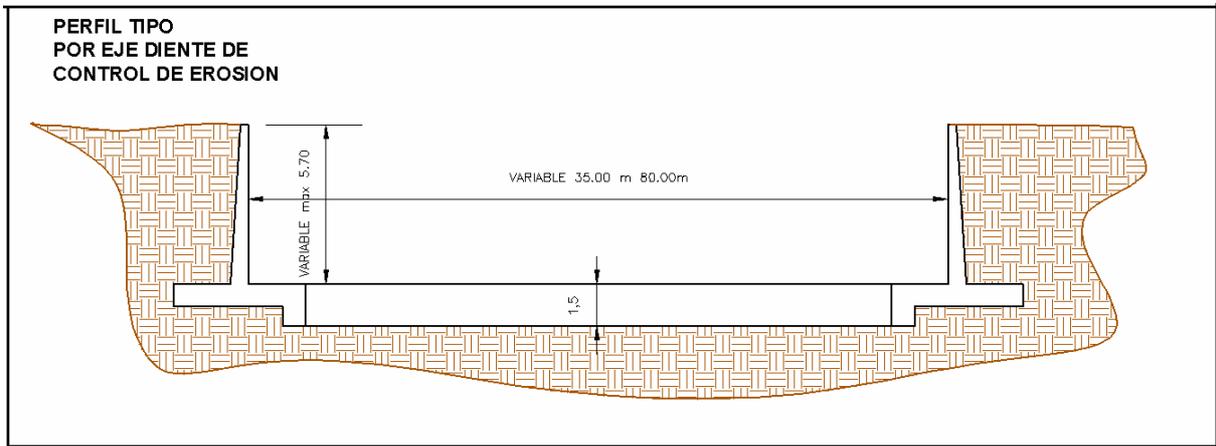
Perfil Transversal Tipo de la Estructura de Descarga por Diente de Control de Erosión
